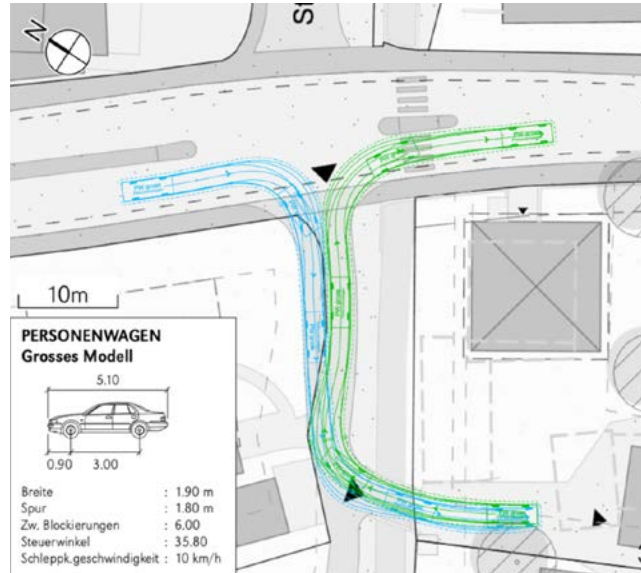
Befahrbarkeit Knoten Dorfstrasse - Erschliessungsstrasse Unterdorf (Quelle: TEAMverkehr.zug, 14.10.2024)
